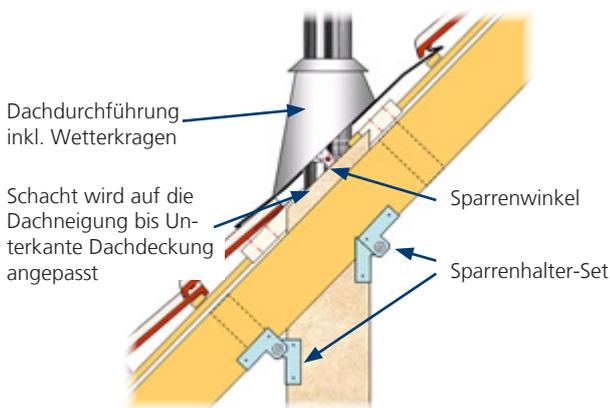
Seitenansicht Dachdurchdringung mit Sparrenhalter
